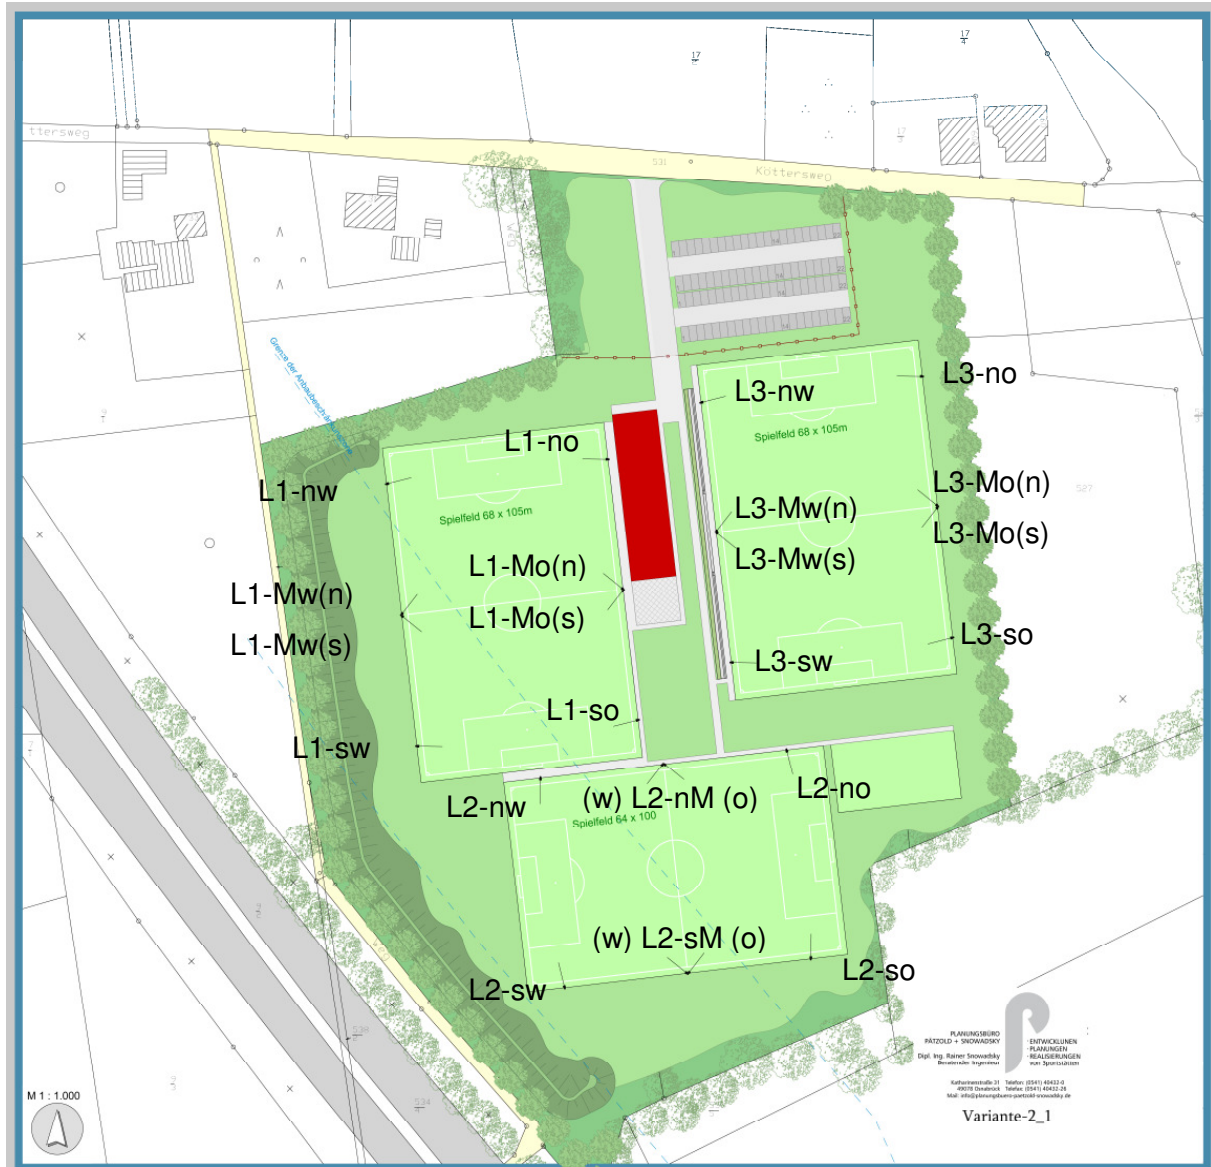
Übersichtsplan aus [4] mit den betrachteten Immissionsorten (Io) und Fahrerpositionen (FP)
